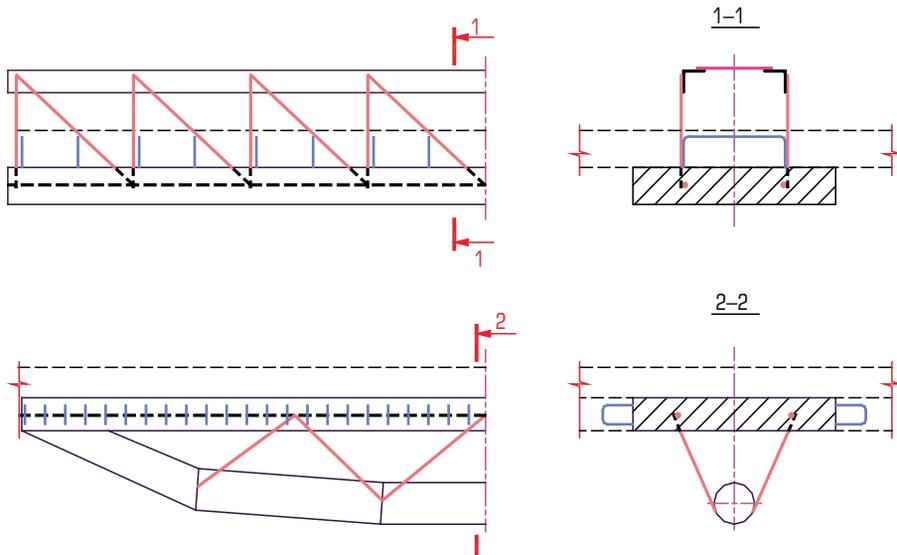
Сборно-монолитное железобетонное перекрытие по патенту РФ 132099
